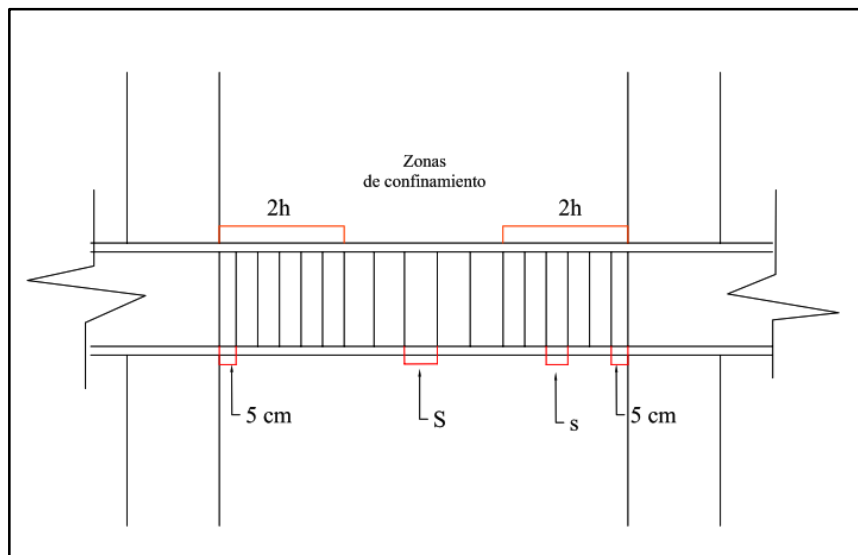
Separación de estribos y longitud de confinamiento en vigas. Fuente: Elaboración propia basado en la NEC [3].
